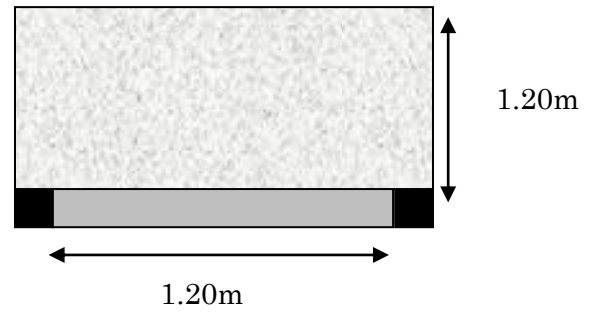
Dalle sur un seul appui (palier de repos)
